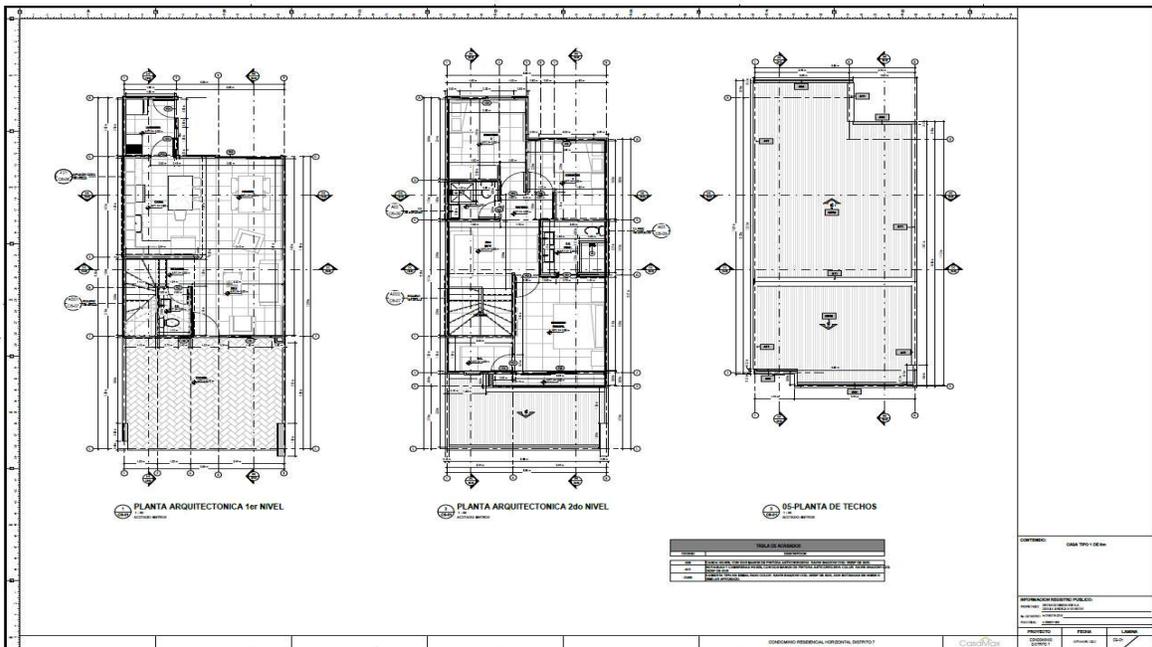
Planta Arquitectónica, Casa Modelo Tipo # 1. Lámina # C6-01
